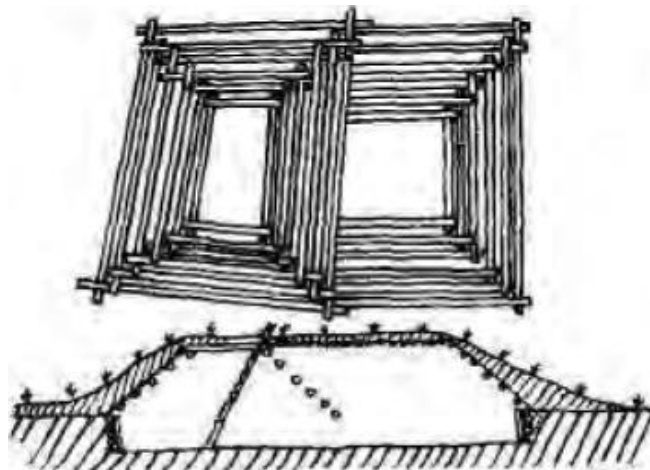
Реконструкция перекрытия М.П. Грязновой [36, с. 405]
